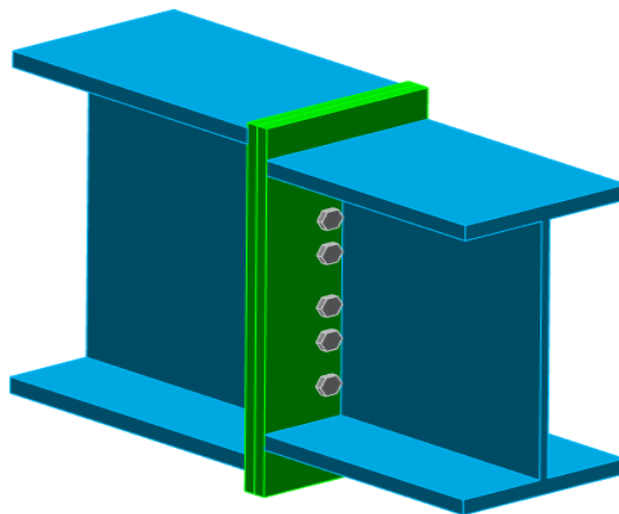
ASSEMBLAGE HEA650-HEA550.
